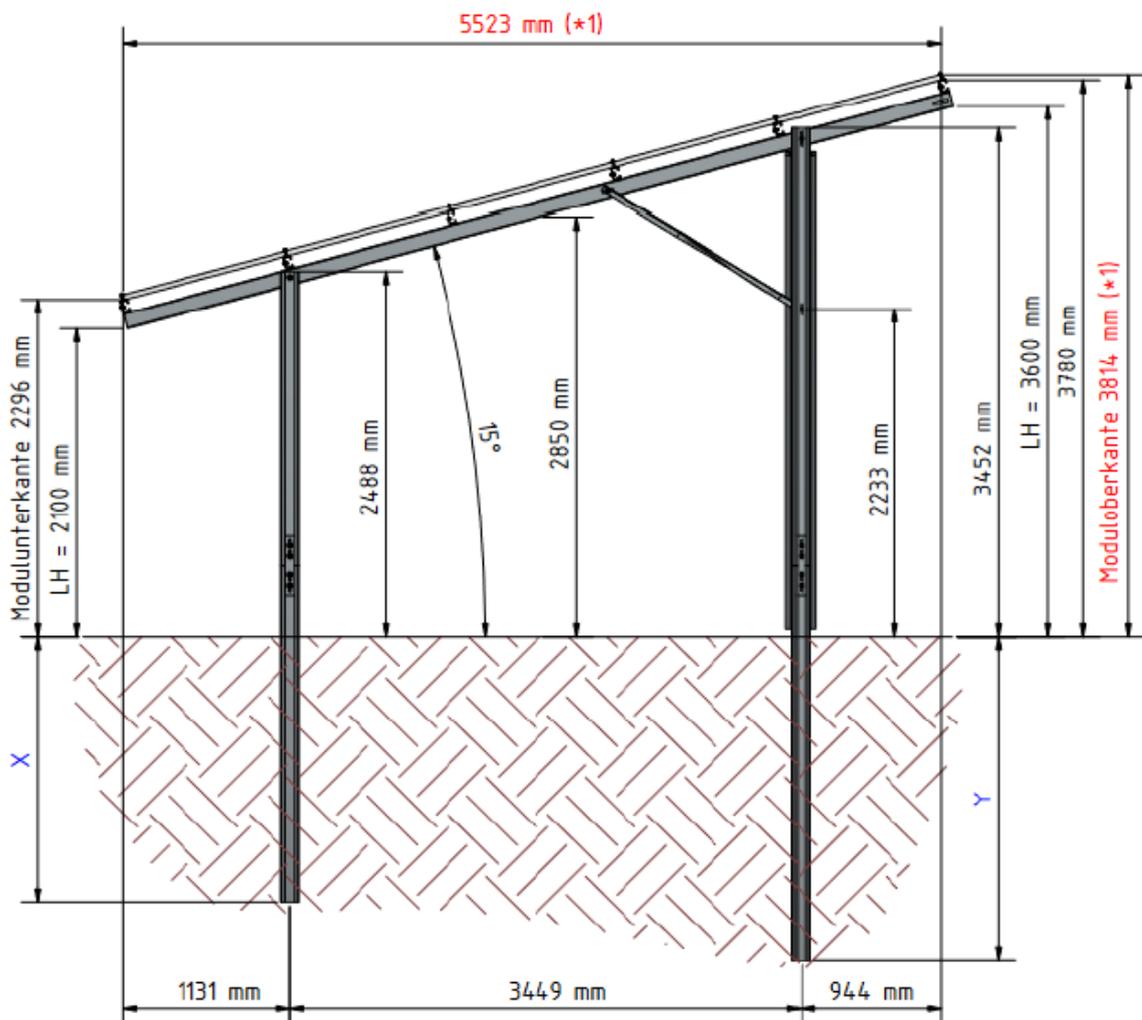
Modulquerschnitt (SUNfarming GmbH)
